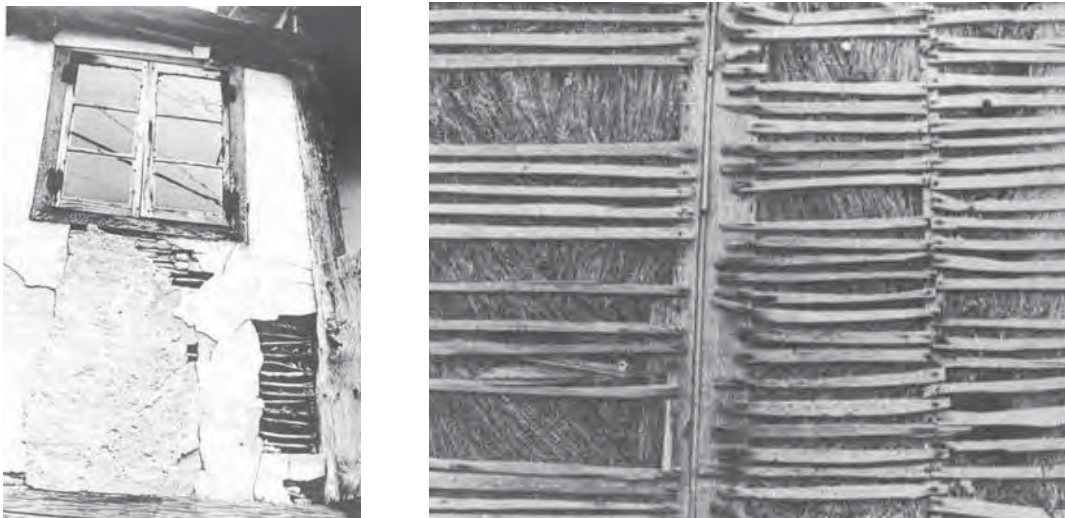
Pared de pallabarro, con detalle donde puede verse el método constructivo. Fuente: Pedro de Llano Cabado, *Arquitectura popular en Galicia*, p.106
